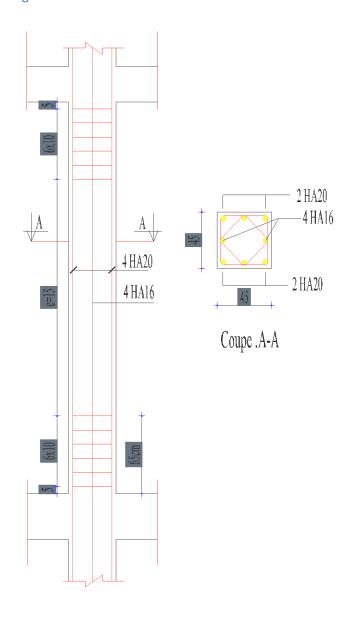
Schémas de ferraillage des poteaux (45 x 45)
